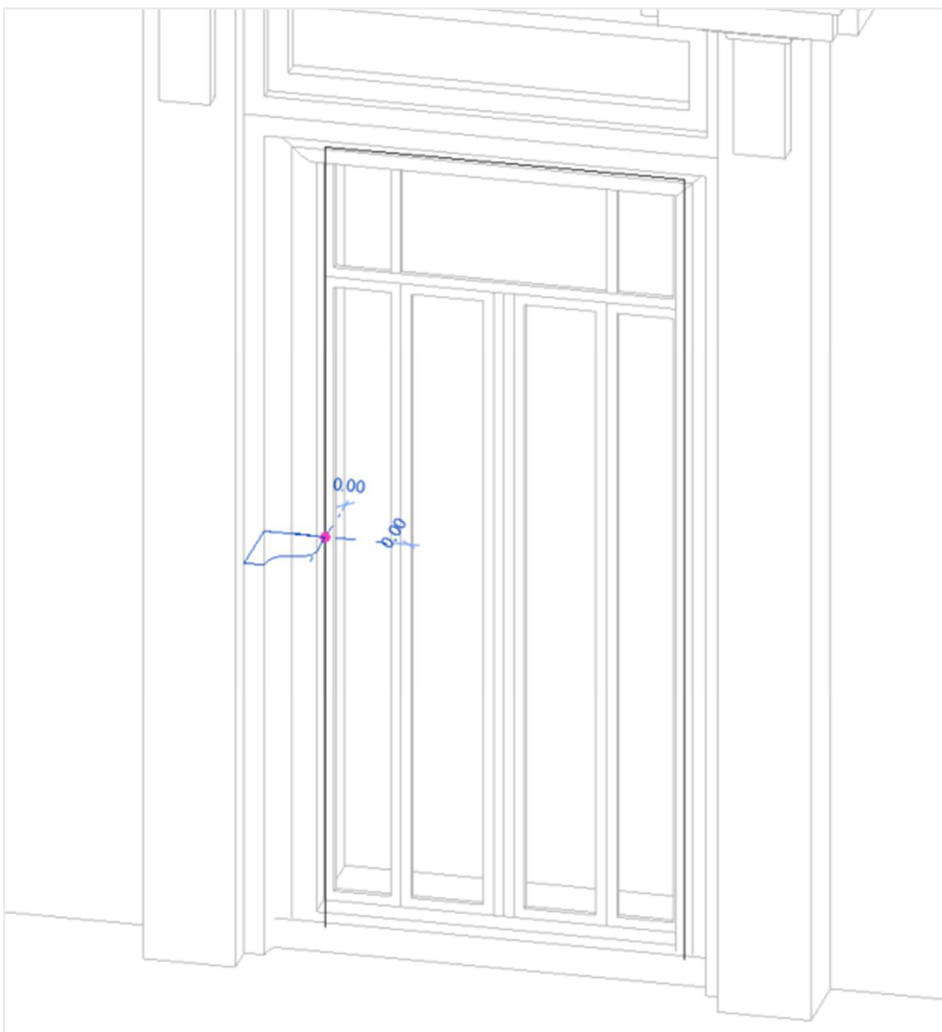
Estrusione su percorso del profilo utilizzato per la modellazione della cornice (Fonte: elaborato dall'autore)
